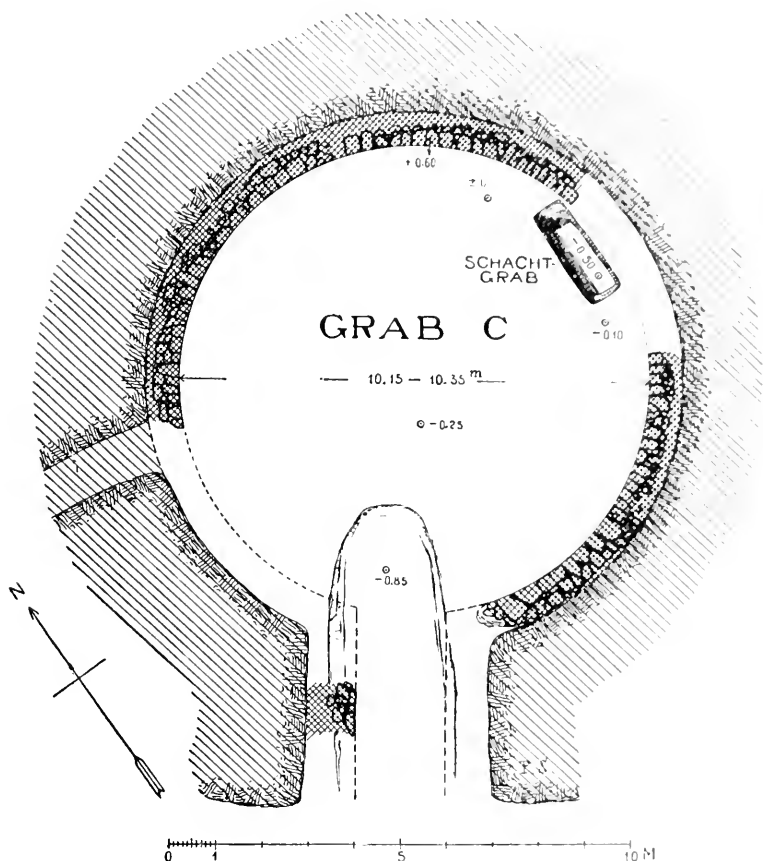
Grundriss des Kuppelgrabes C.
